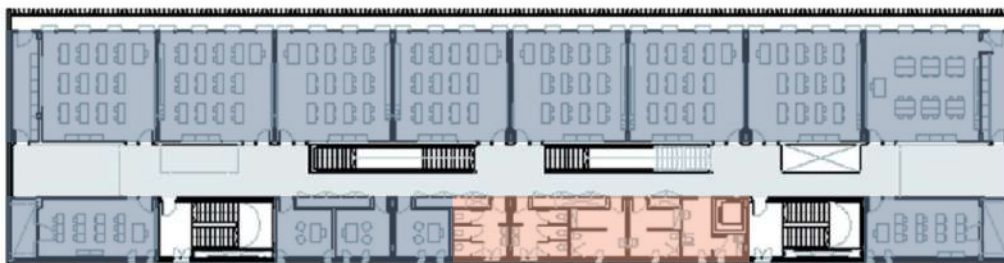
Planta baixa segundo e terceiro pavimento - Fonte: Archdaily, 2014
